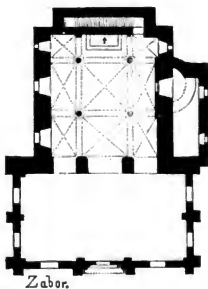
Grundriss der Kirche von Zabor. (Nach Wocel.)
